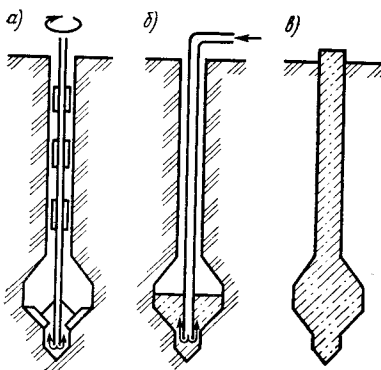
Изготовление буронабивных свай с уширенным нижним концом (по Б. И. Далматову):
